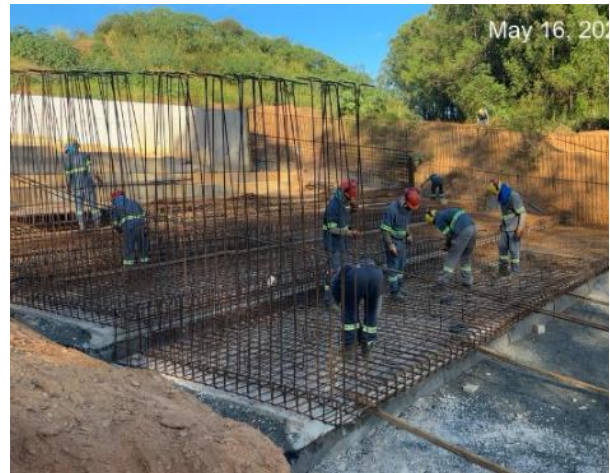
Execução de armação e formas em piso e paredes – módulo 22
